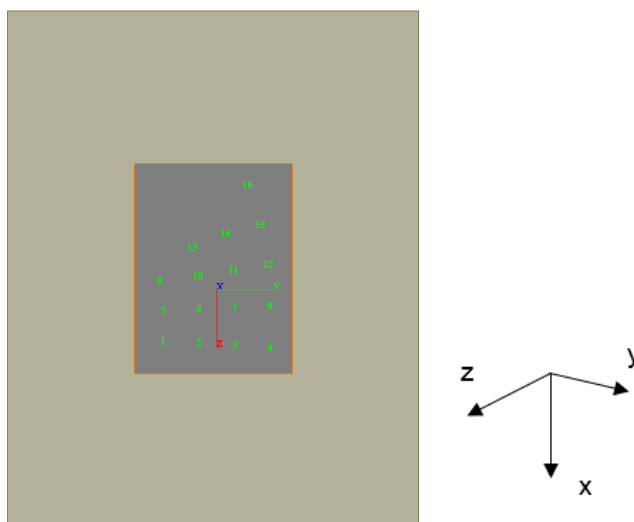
Spalla A: Pianta della palificata e sistema di riferimento utilizzato nel software GROUP2016.
